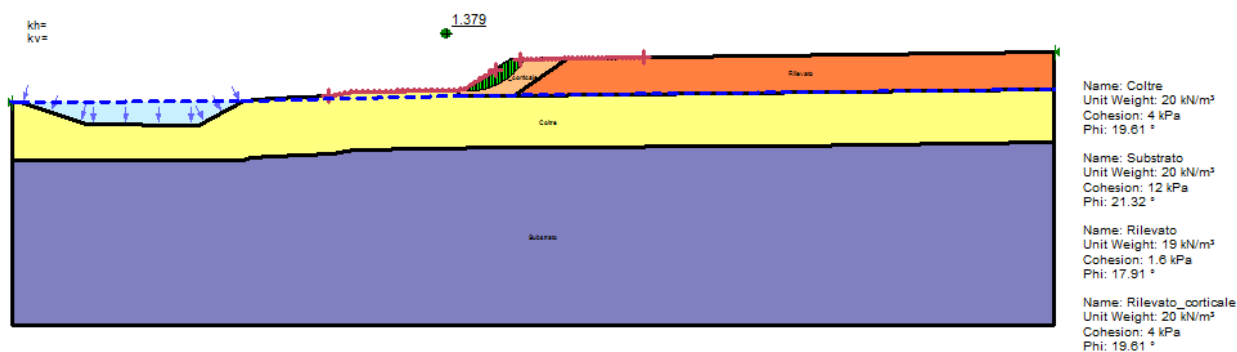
Sezione G; condizione statica. Verifica di stabilità globale.
